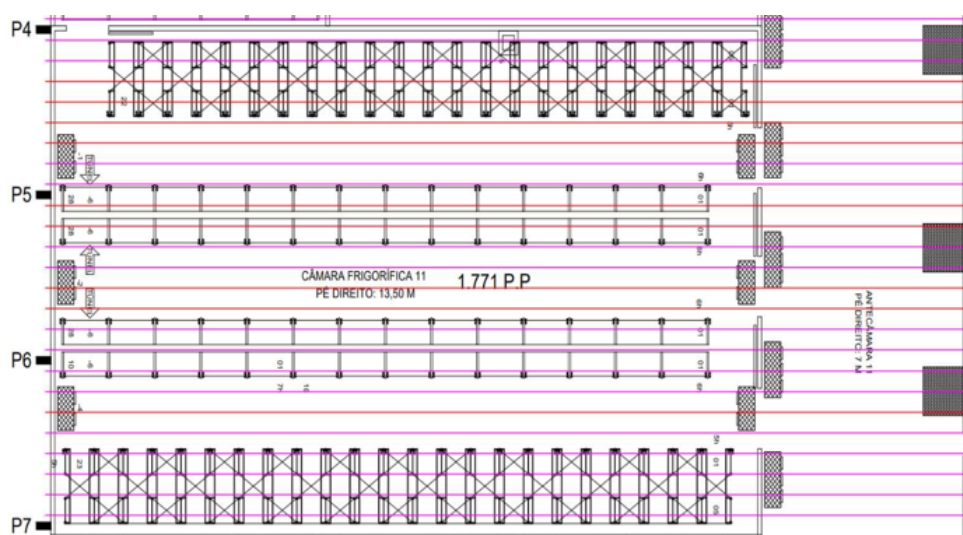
Recorte da planta baixa da câmara fria, com destaque para os tubos.
